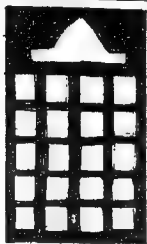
منزل محمد حمد السطح - مقطع أفقي
